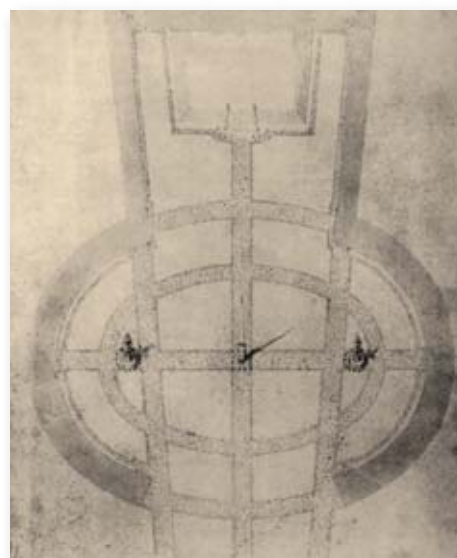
Piazza S. Pietro. Progetto per la pavimentazione (BAV, Chig., P. VII. 9, f. 15r). La planimetria viene disegnata con ogni probabilità nei primi mesi del 1667. Si noti la posizione arretrata del terzo Braccio, studiata dal Bernini dal febbraio 1667
